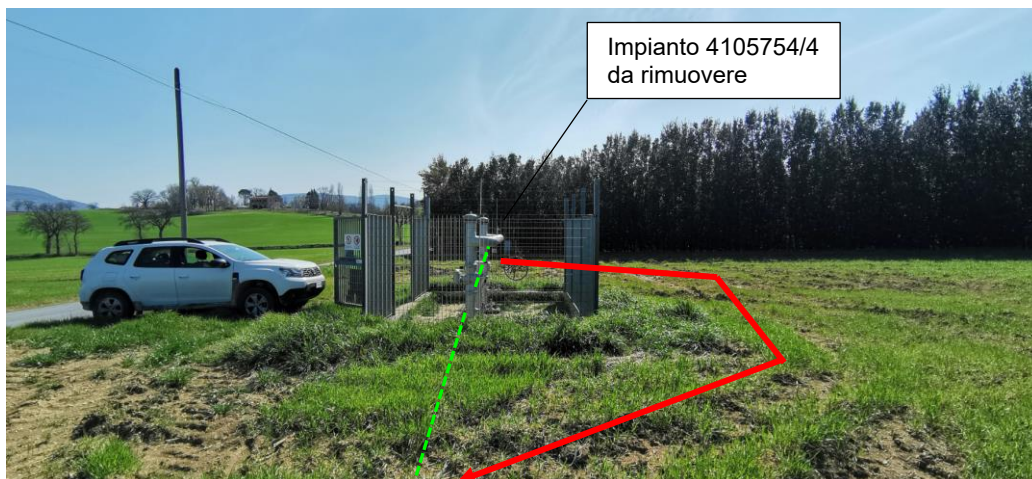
“Variante Potenziamento Derivazione per Fabriano – rimozione 4105754/4 DN 400(16”), DP 75 bar”
